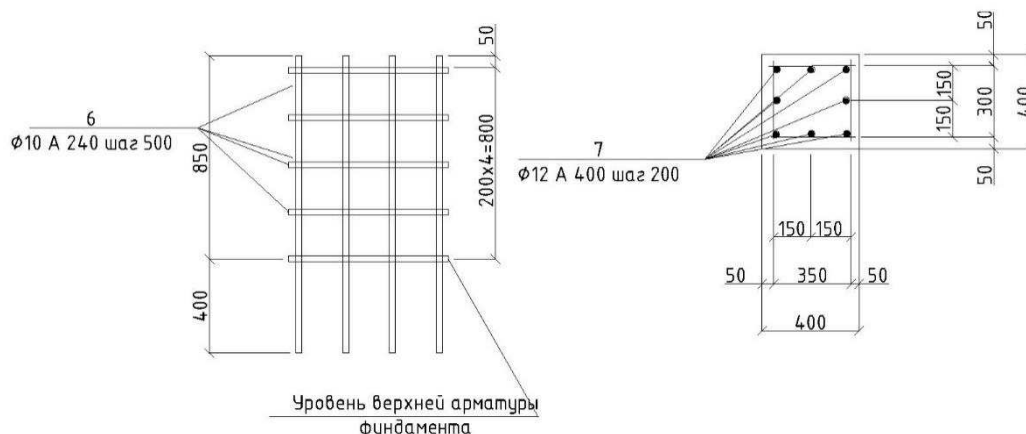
Соединение монолитной железобетонной колонны с монолитным фундаментом
